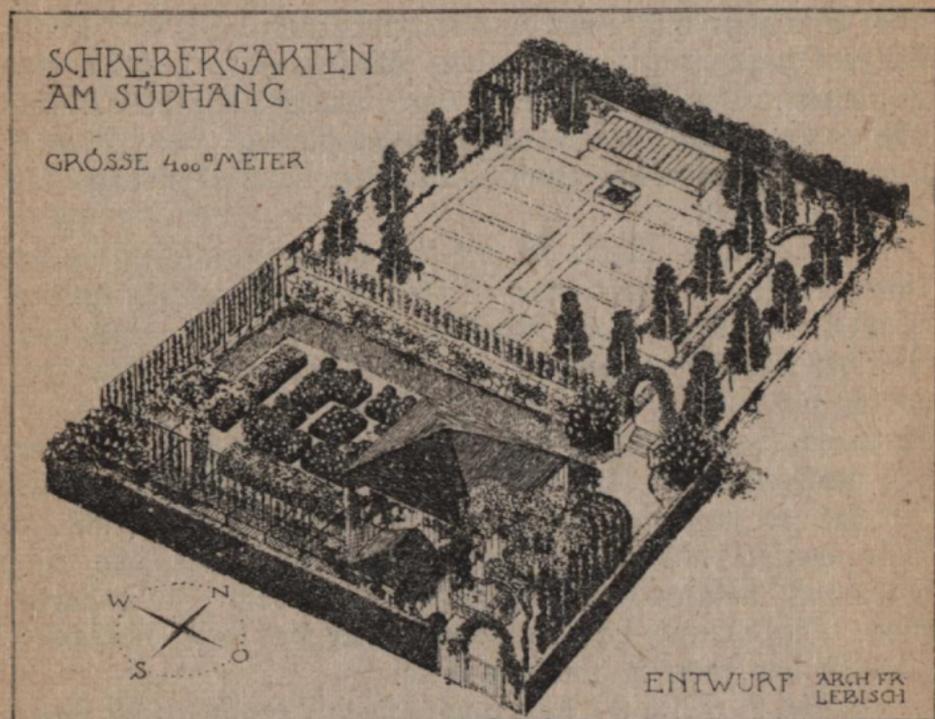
Schaubild zu dem Plan in Fig. 7.
